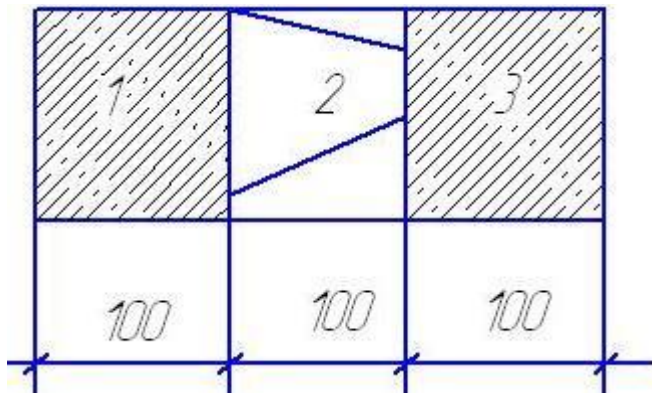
Конструкция трехслойной железобетонной стеновой панели:
